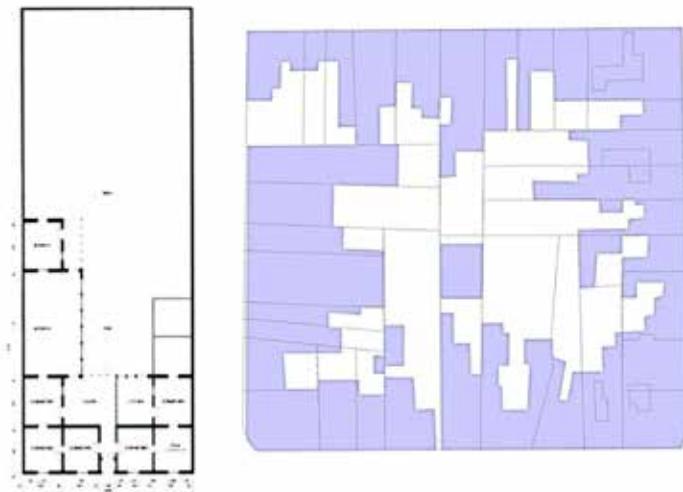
En la Derecha: planta de vivienda. Fuente: Santa Ana, donde la ciudad tiene memoria. Junta de Vecinos Barrio Santa Ana & SurMaule, 2005. En la izquierda: Manzana censal con subdivisión predial y construcciones. Fuente: CENSO 2002.
